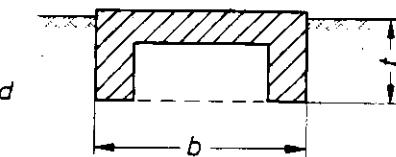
Maßgebende Längen für den Grundbruchnachweis bei unregelmäßigen Fundamentformen
